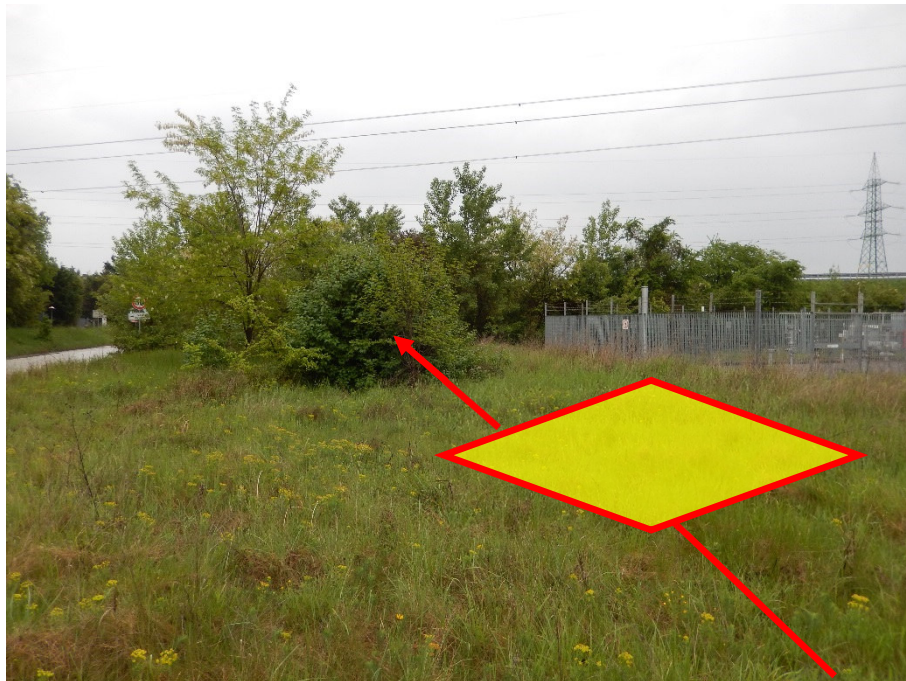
IMPIANTO PIL TC IN PROGETTO (INTERVENTO N.9)
